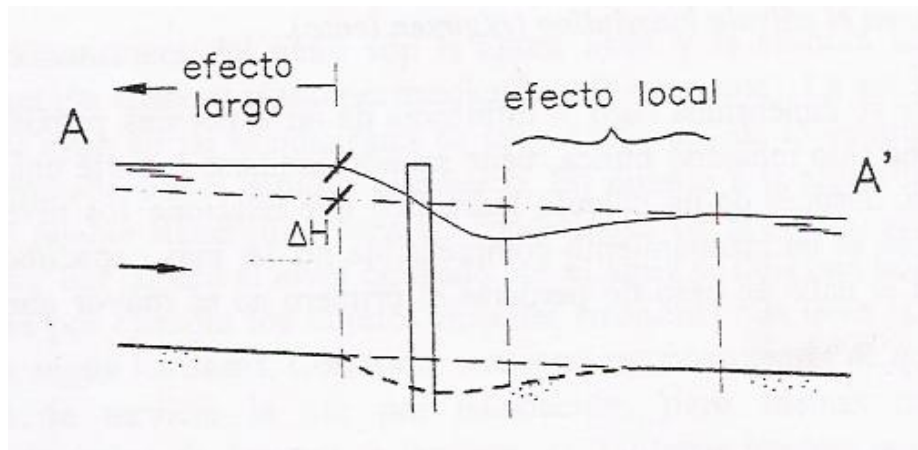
Vista en perfil de las características hidráulicas de paso de un puente.
